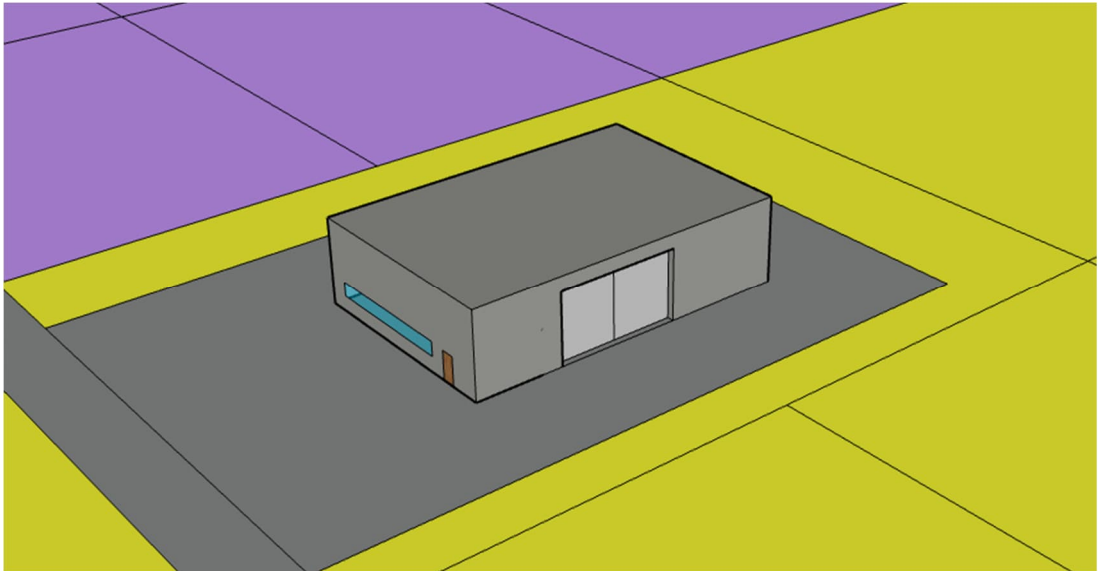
Bestehende Autowerkstatt mit einer Grundfläche von 384 m²
